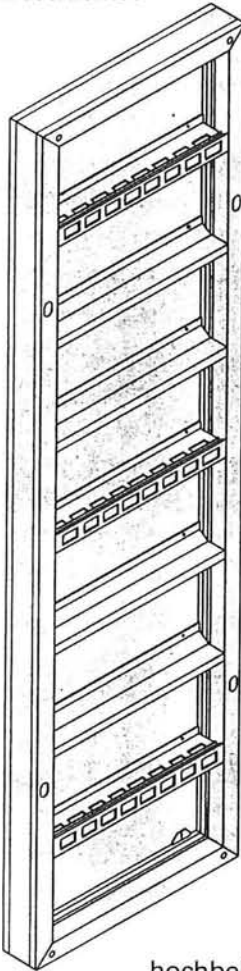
Trapezium-drager bekisting voor ronde wand.
